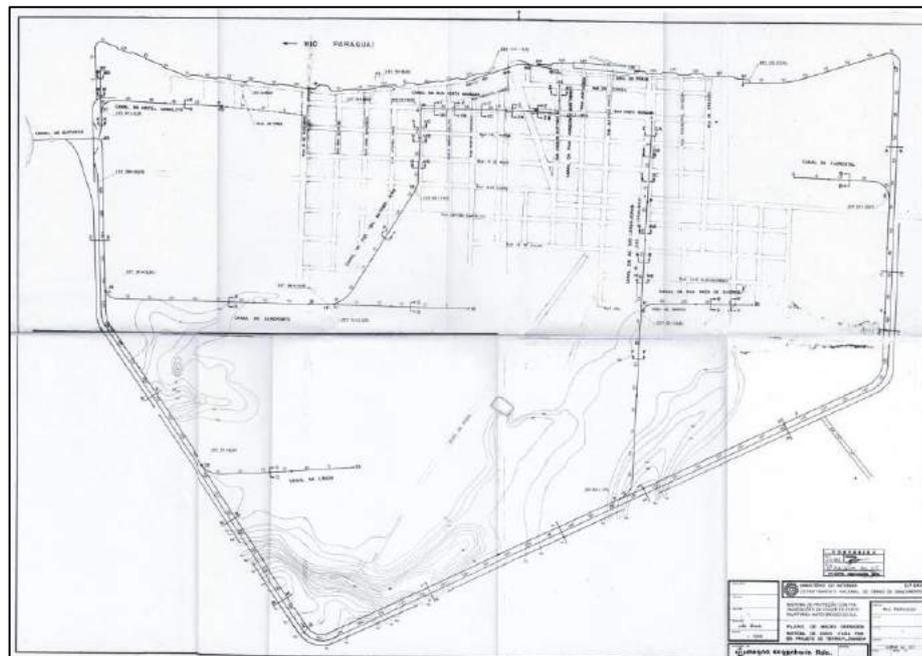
Planta inicial dos contornos da barreira de proteção contra as inundações.
